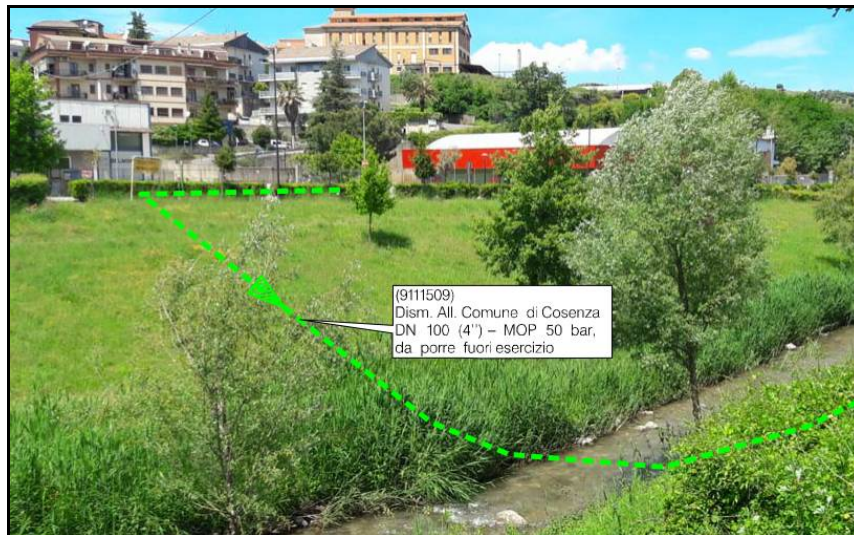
/D – Foto 11 – Attraversamento fluviale (dismissione in verde)
